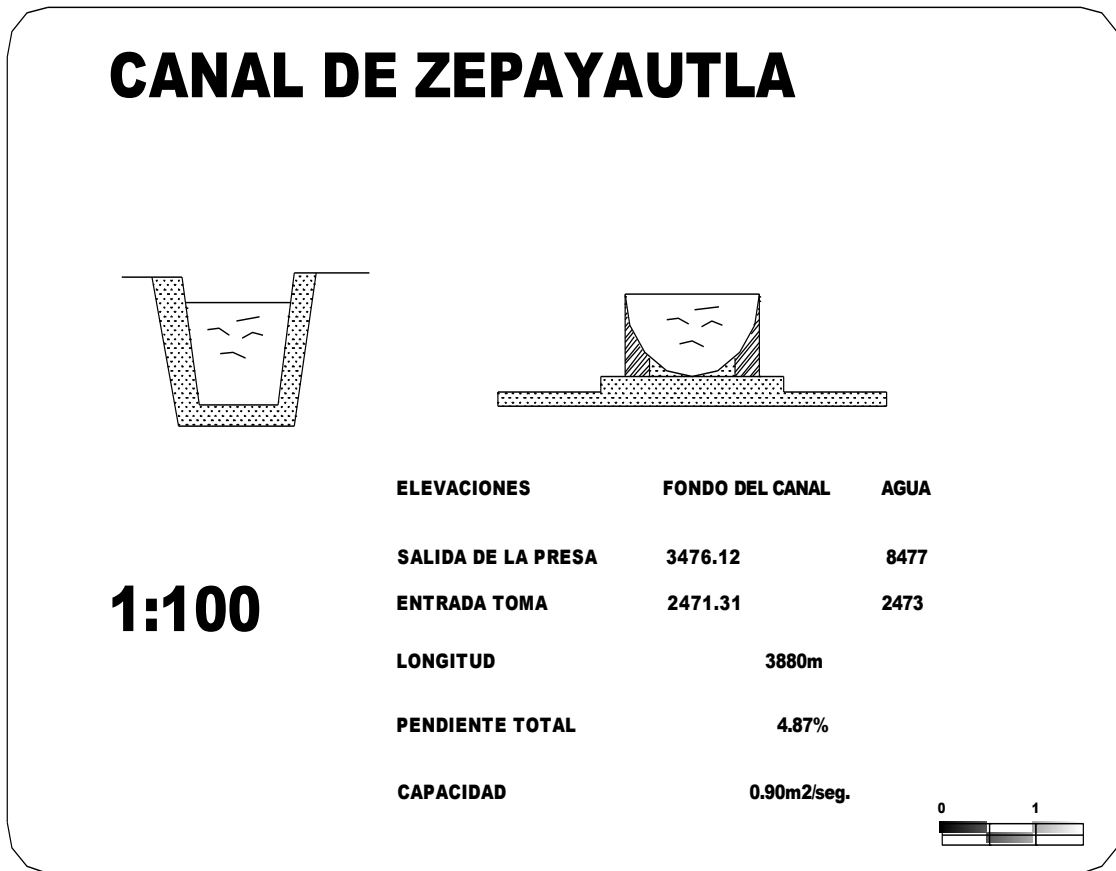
Imagen del plano que muestra las características constructivas y medidas de los canales que corren de la presa Zepayautla a la cámara de presión. Dibujo Eduardo López Cruz.
